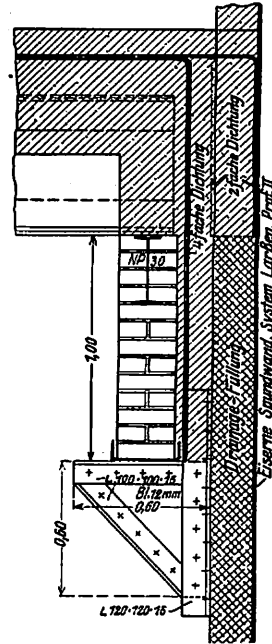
Behelfslagerung der Tunneldecke (Landwehrkanal-Unterfahung).
